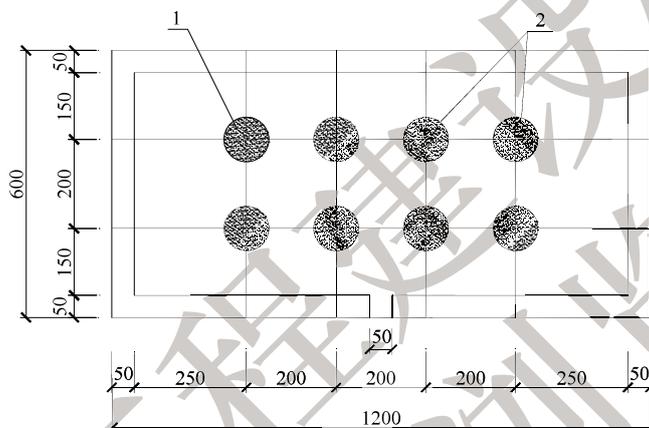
点框粘法示意（尺寸单位：mm）
